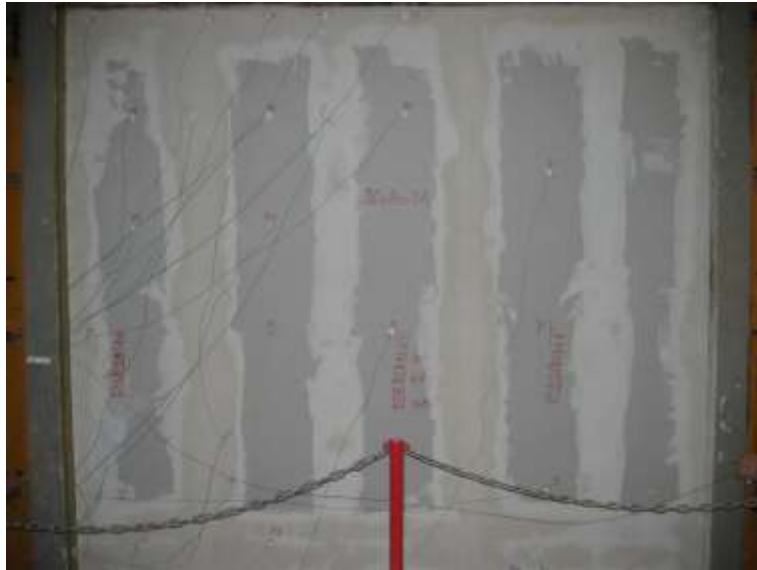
Eingebaute Testkonstruktion in den Prüfraum für Wandkonstruktionen.
